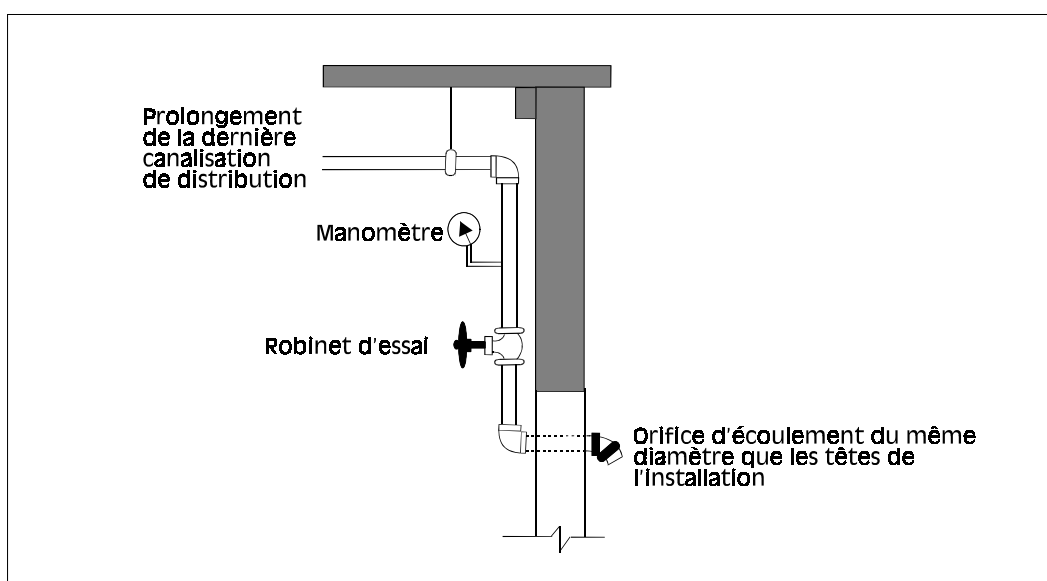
α : Dispositif d'essai point F avec rejet à l'extérieur
